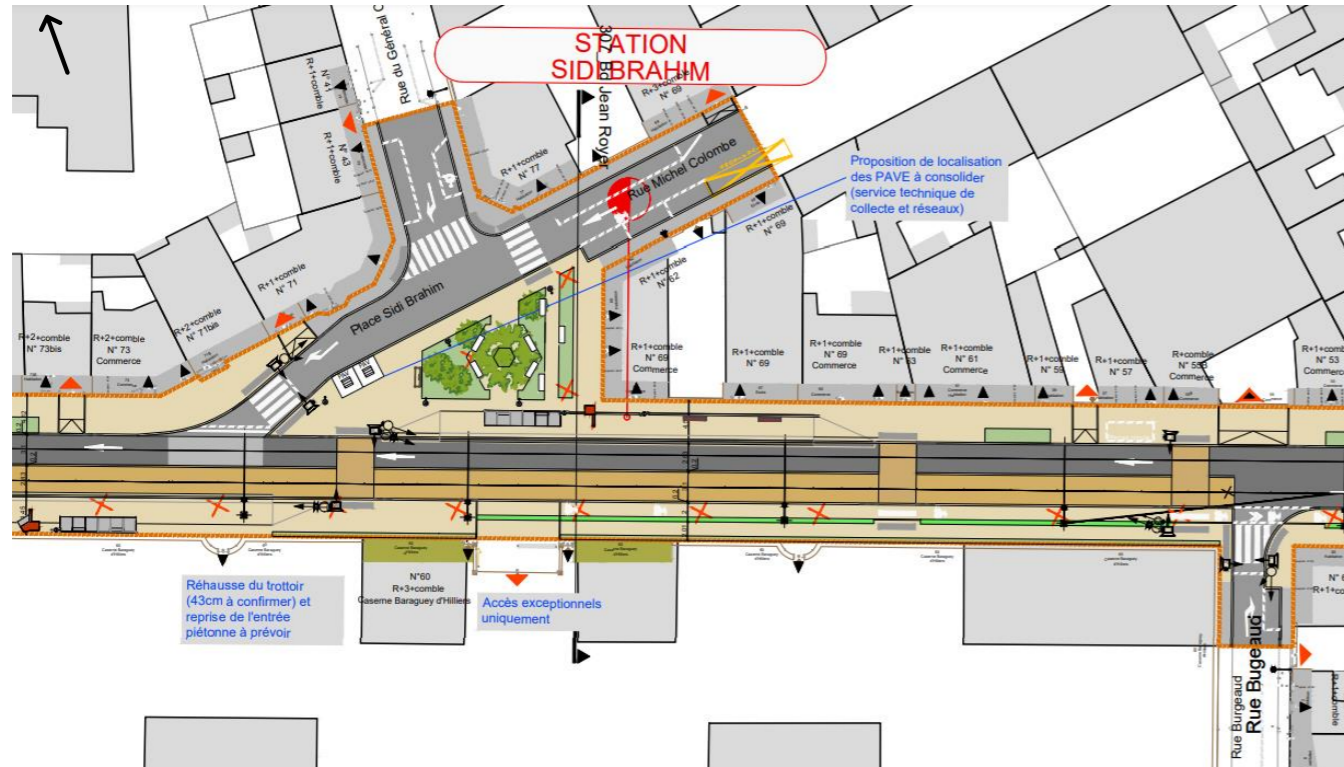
PLAN DE LA STATION SIDI BRAHIM
